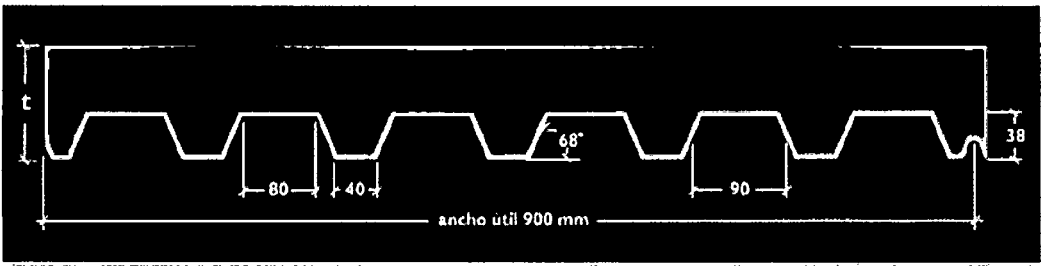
3: Detalle del perfil AD-900 (Acero Deck, 2013).
